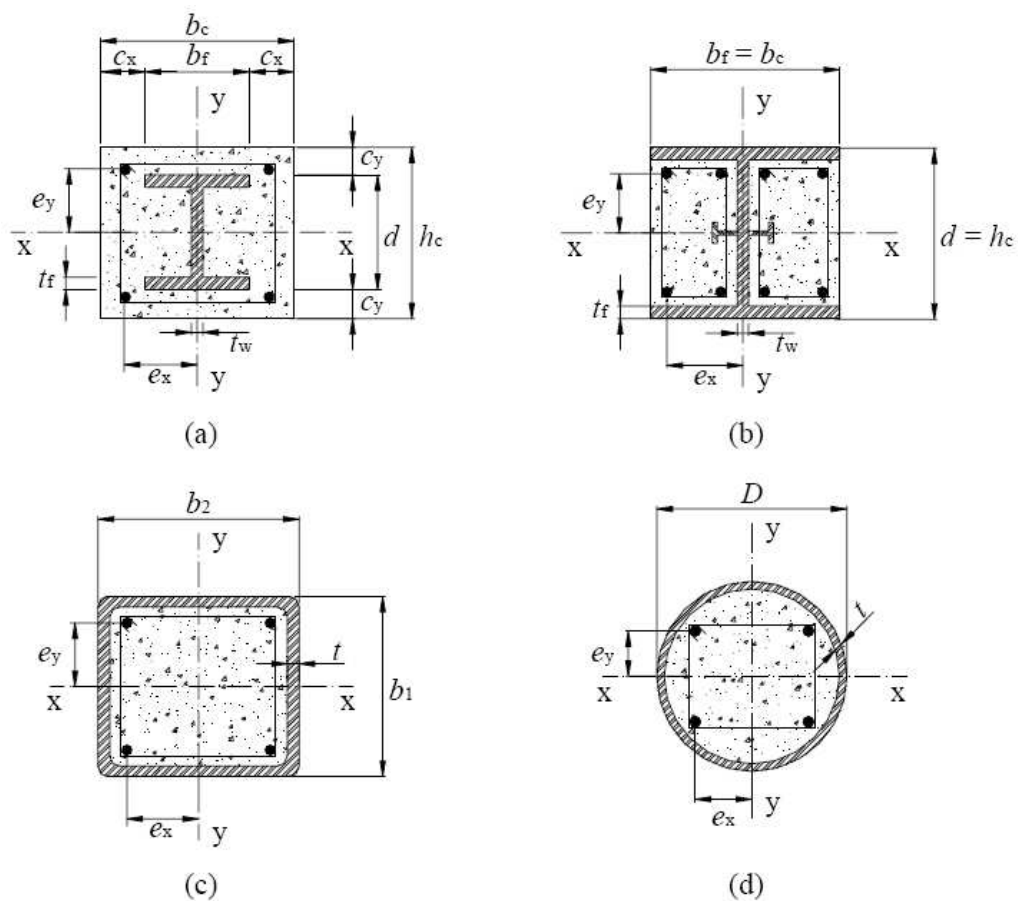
Tipos de seções transversais de pilares mistos.
